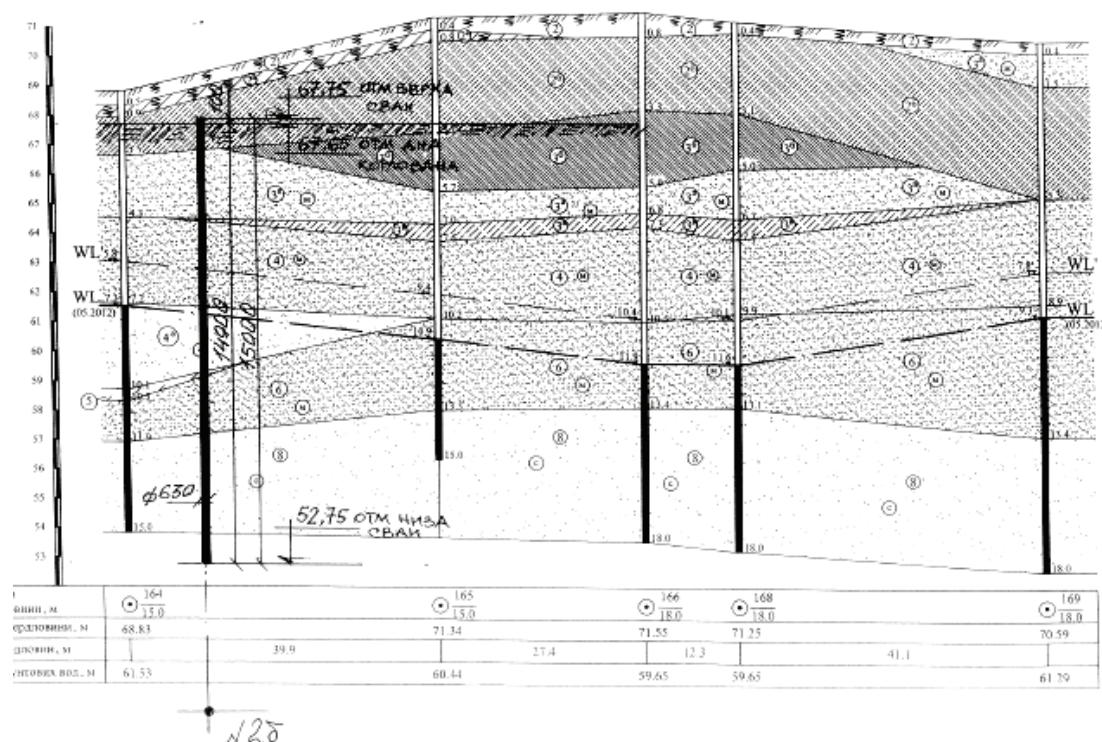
Инженерно-геологический разрез по площадке строительства.
